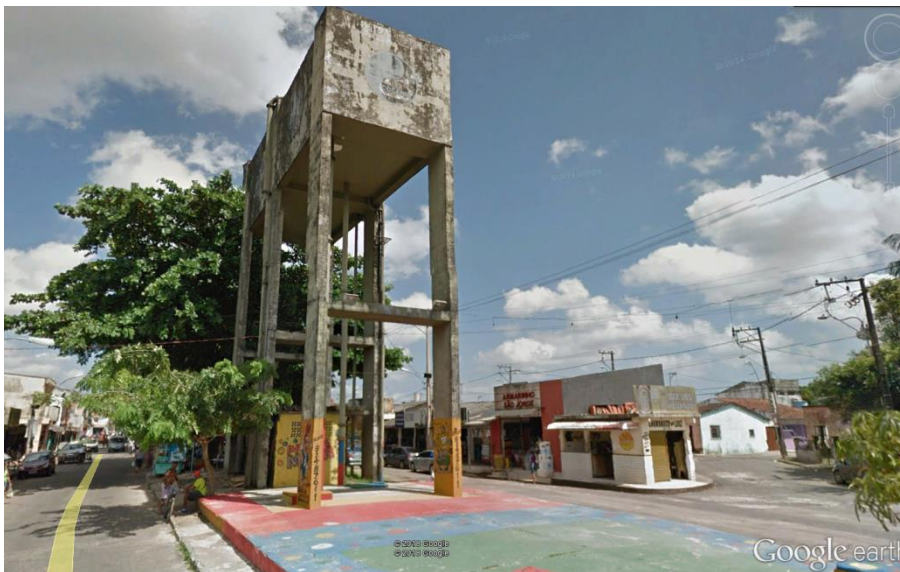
Vista da Área do Setor Panorama XXI – Poço
